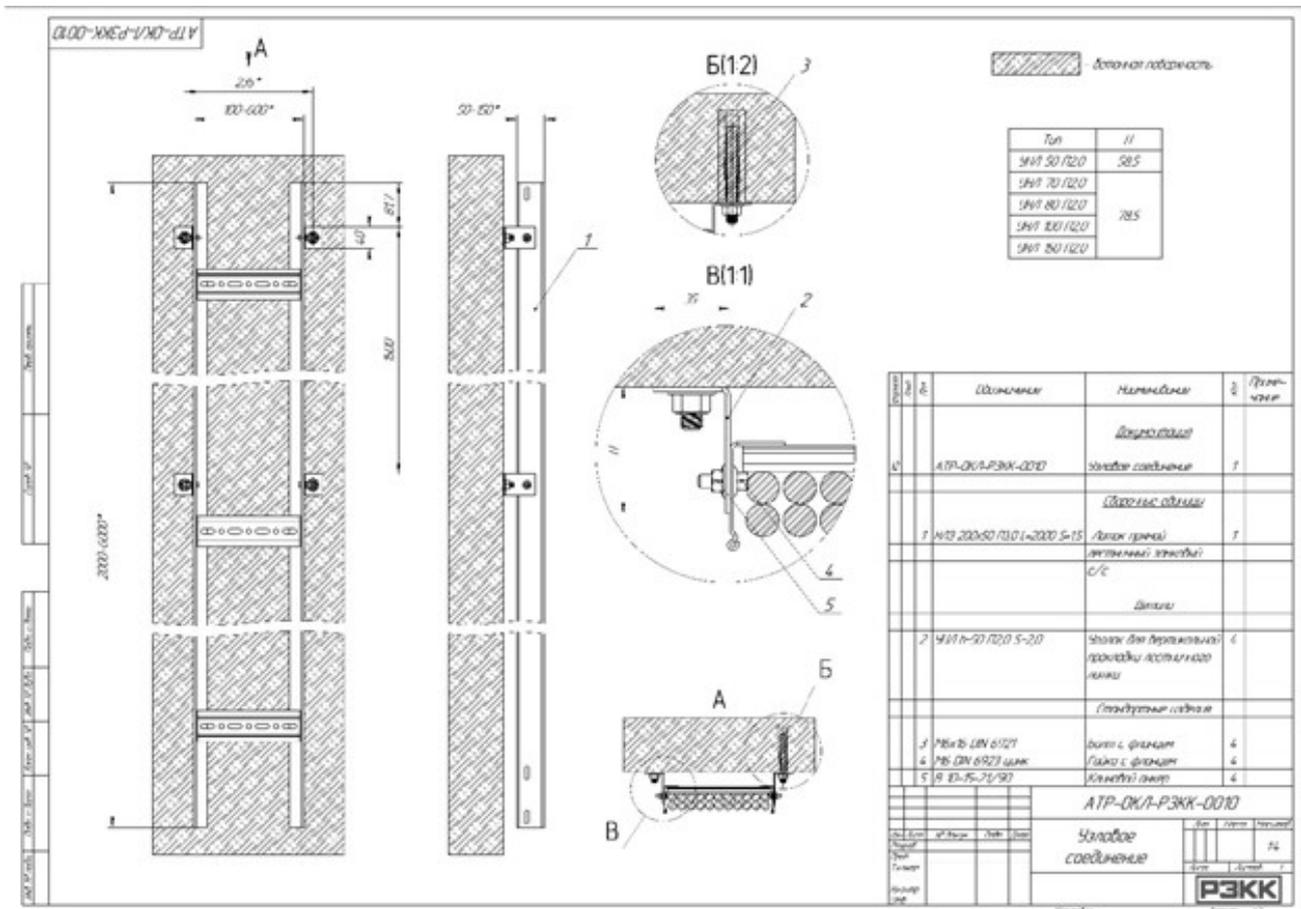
Вертикальная прокладка. Крепление к стене (лестничные лотки).
